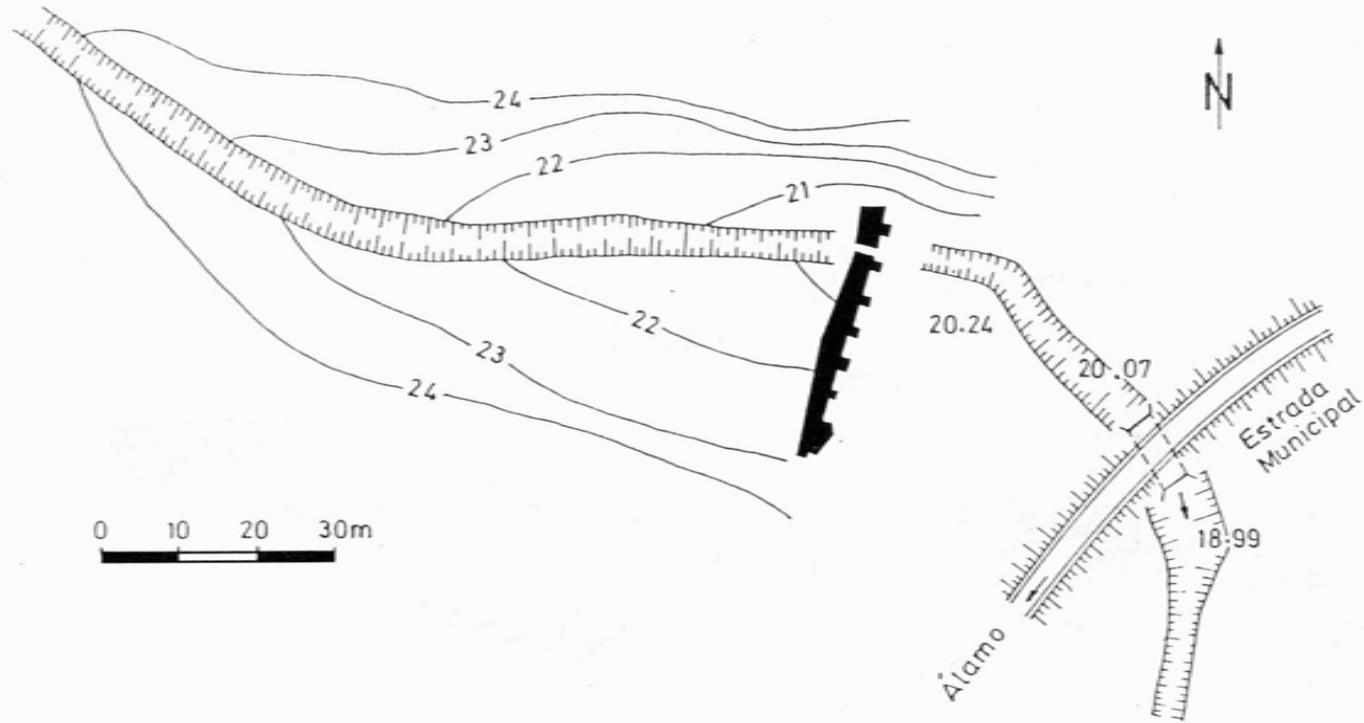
Barragem do Álamo (Alcoutim). Planta da albufeira.
